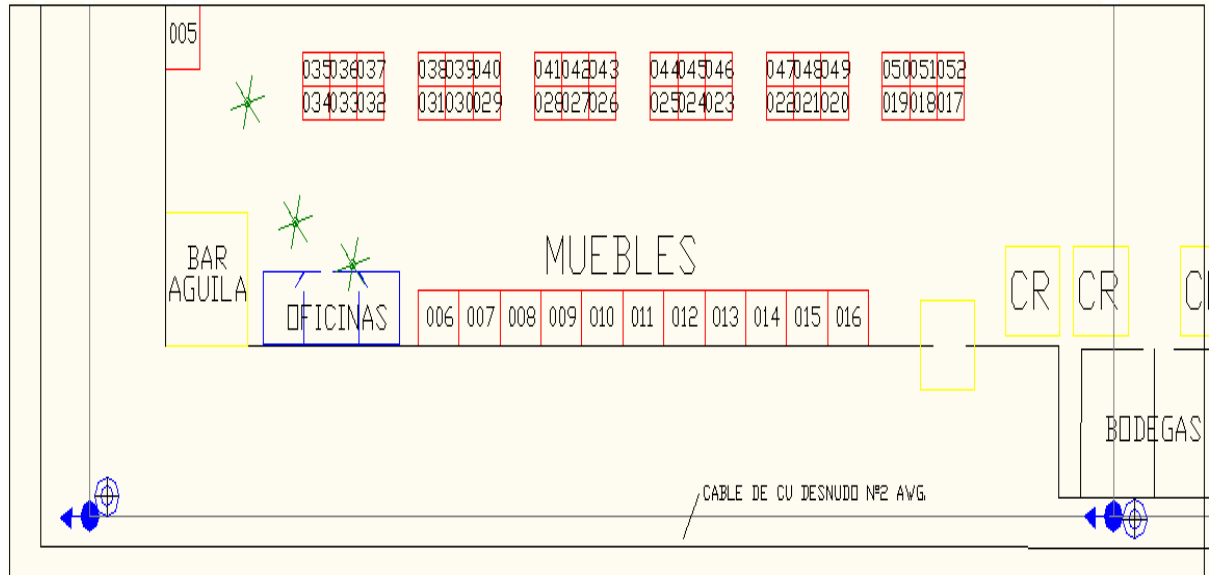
Detalle de planimetría puntas captadoras en postes.
